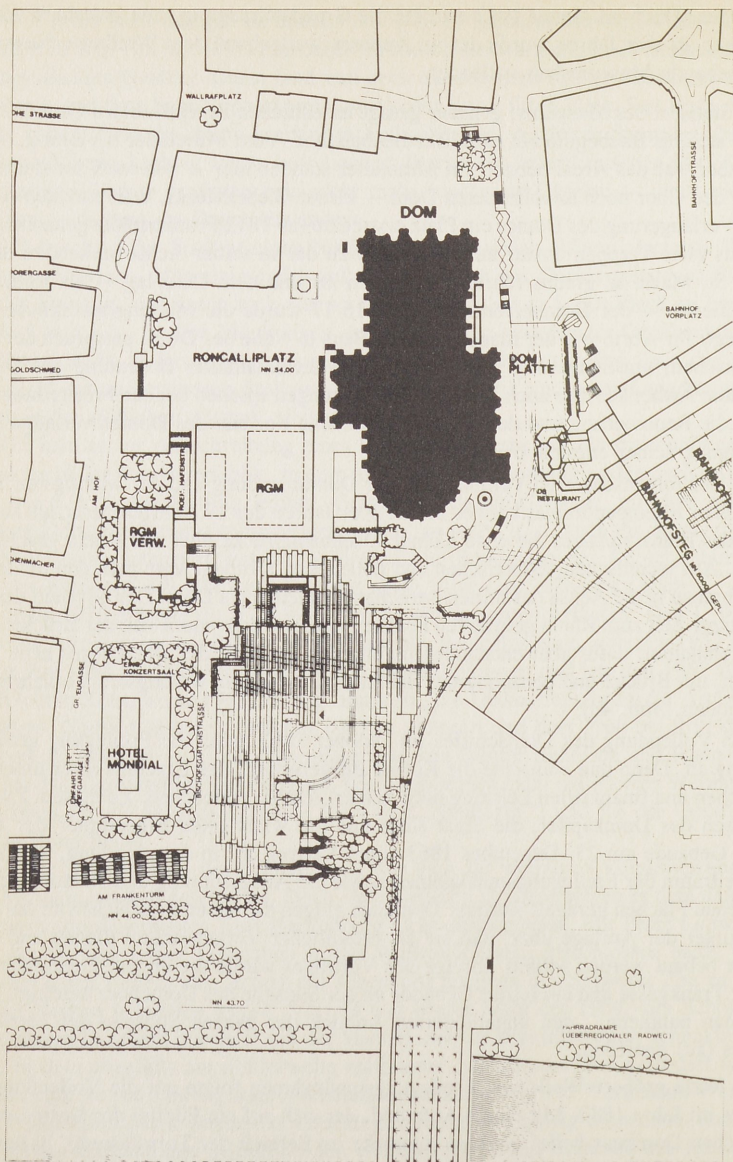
Köln, Lageplan der Domumgebung mit dem Museumsneubau (nach: Zwischen Dom und Strom, Köln 1986, S. 38 f.)
